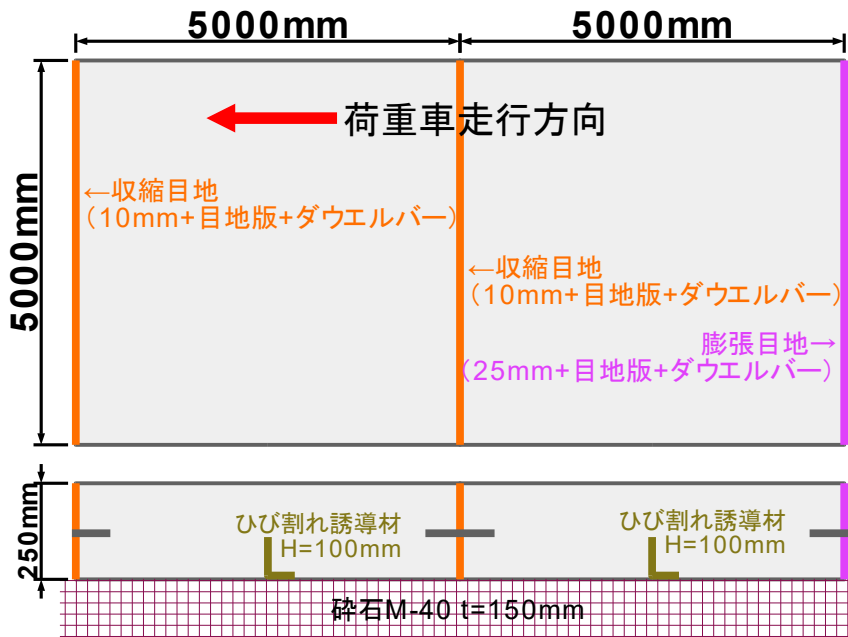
コンクリート舗装版の寸法・目地配置等
